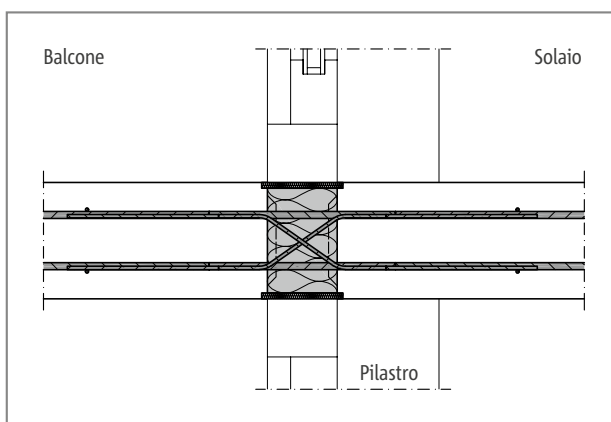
Schöck Isokorb® XT tipo D: sezione costruttiva; solaio piano
